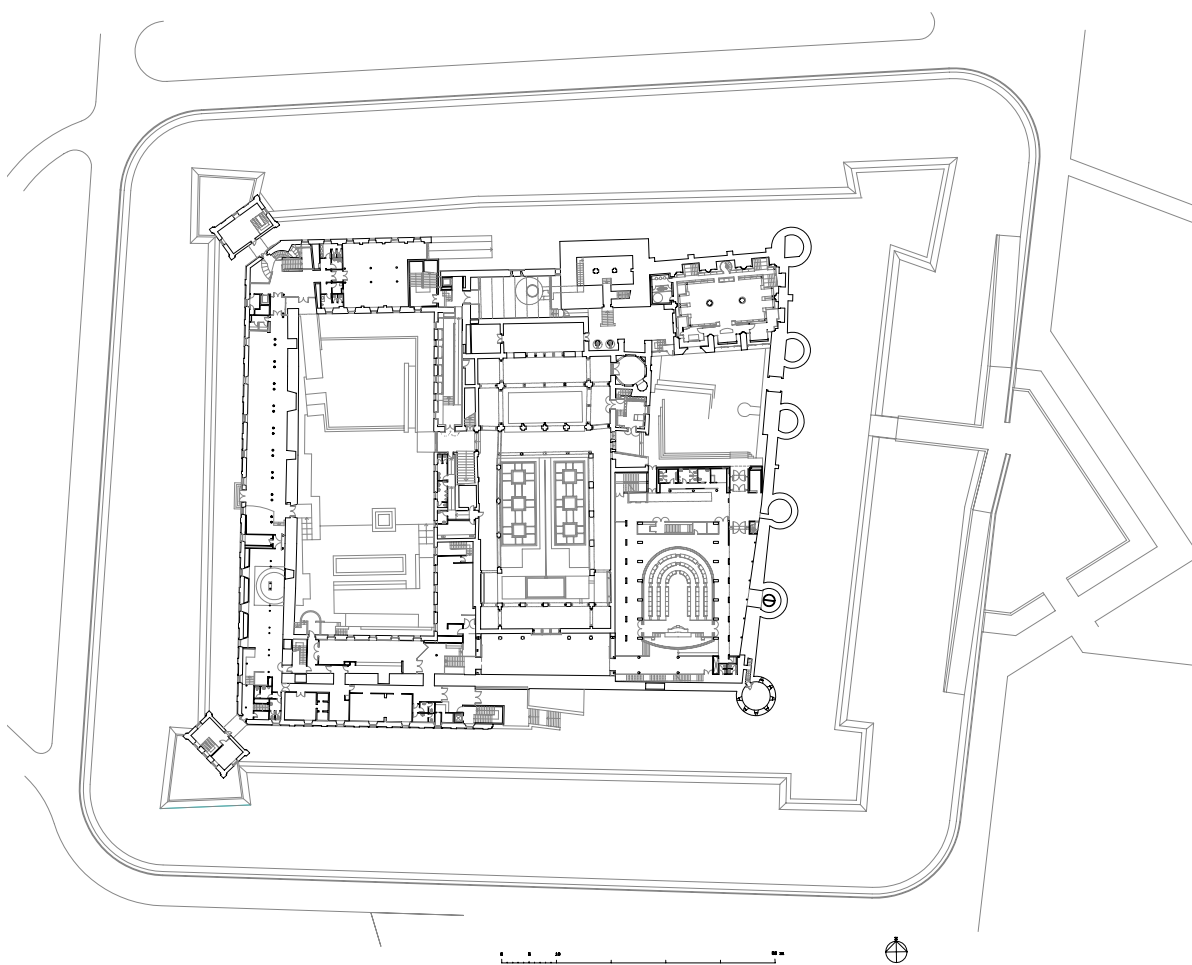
Planimetría actual del recinto completo. Planta de acceso
